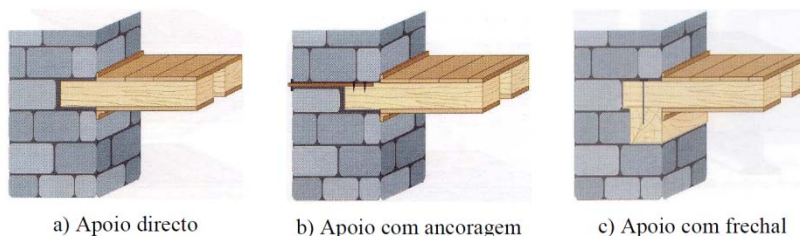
Ligações entre pavimentos e respectivas paredes de apoio (Appleton, 2003)
